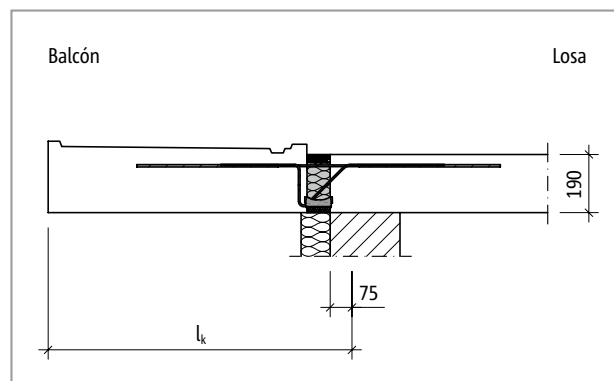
Schöck Isokorb® T tipo K: Sistema estático
